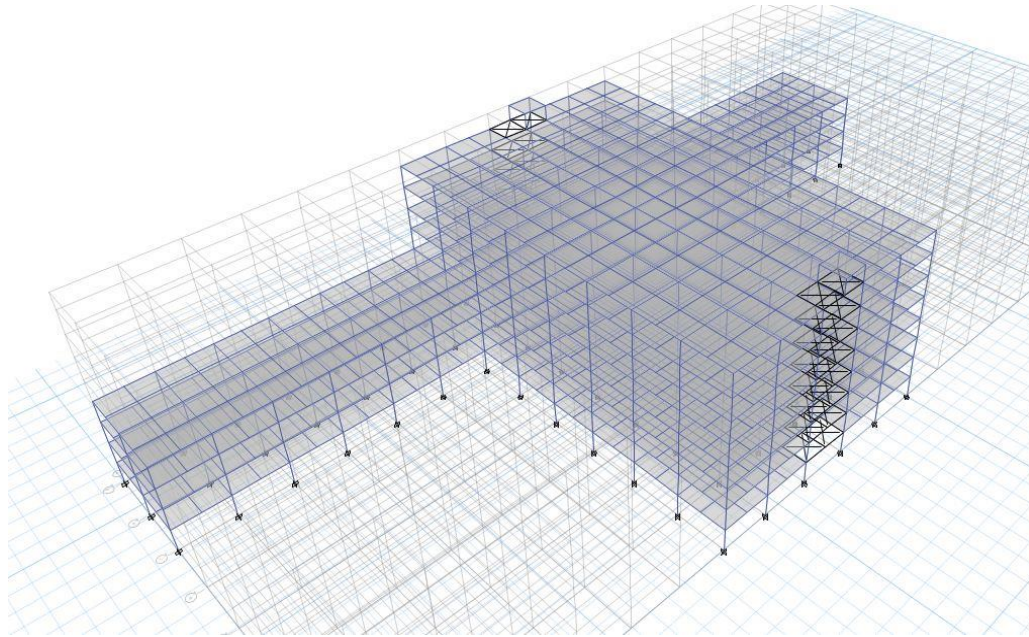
Denah Lantai 3 - Lantai 4 Model A1
